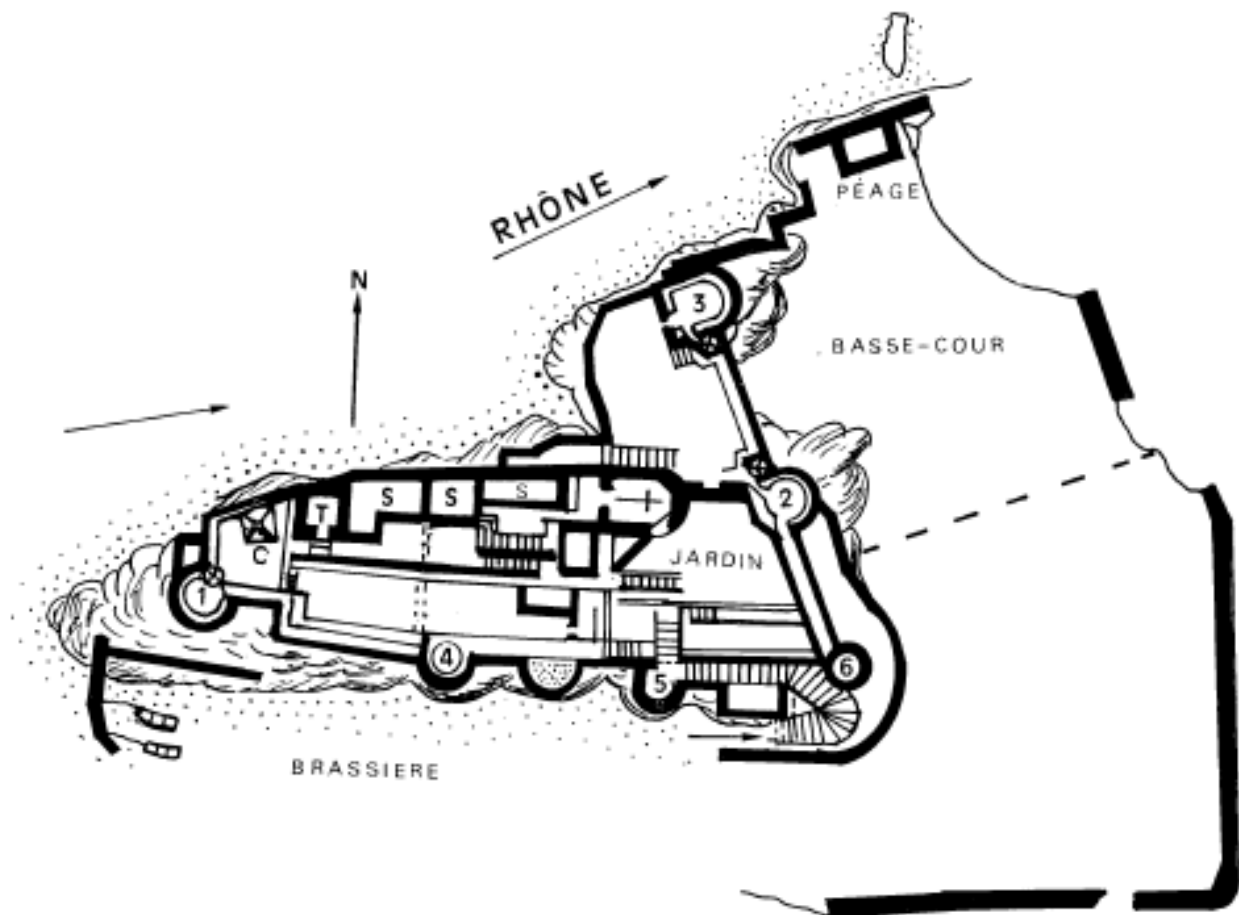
Restitution du plan du château d'après relevé de Fr. Martin, en 1752.
